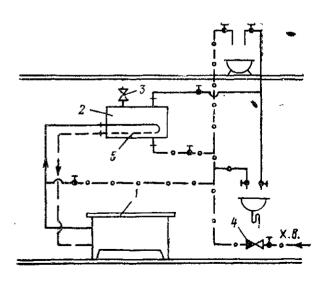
Схема с емкостным подогревателем 1—плита (генератор тепла); 2—водопагреватель; 3—предохранительный клапан — 20 мм; 4—обратный клапан; 5—змеевик
